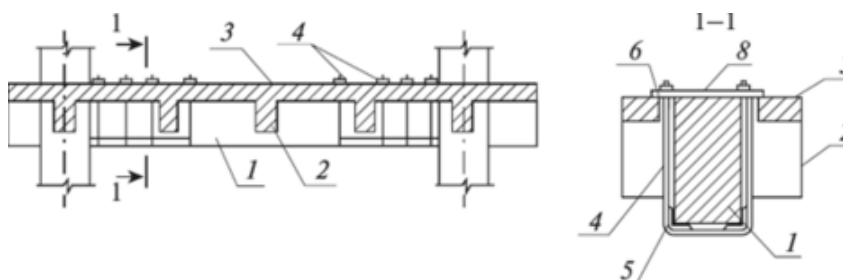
Усиление главных балок монолитного железобетонного перекрытия установкой стяжных хомутов на опоре: 1 – усиливаемая главная балка; 2 – второстепенные балки; 3 – плита; 4 – металлические стяжные хомуты с гайками; 5 – подкладка из уголка; 6 – отверстия, просверленные в плите для пропуска хомутов
